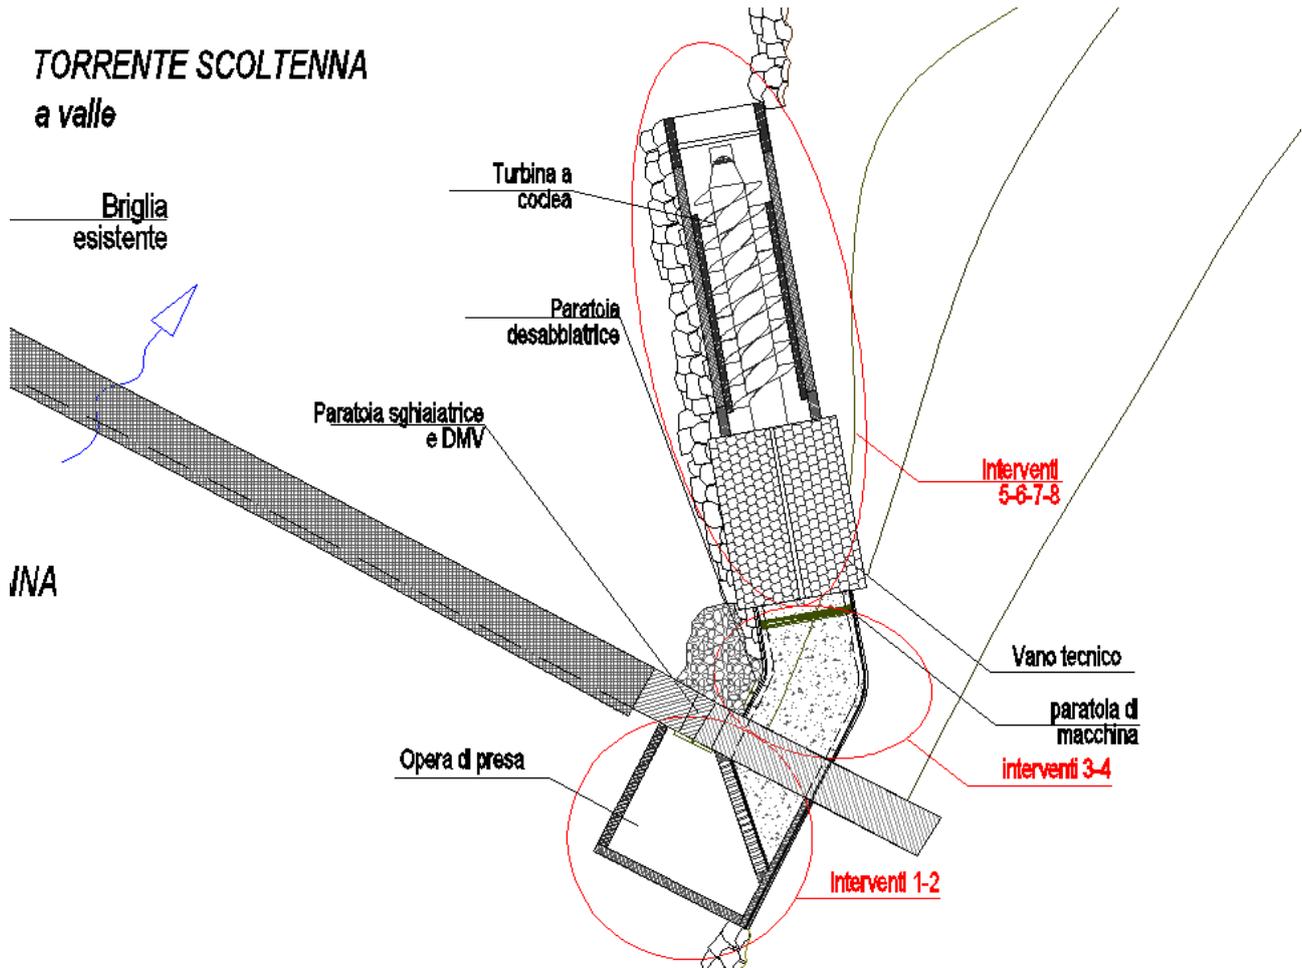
Planimetria schematica riportante la localizzazione degli interventi ivi descritti
